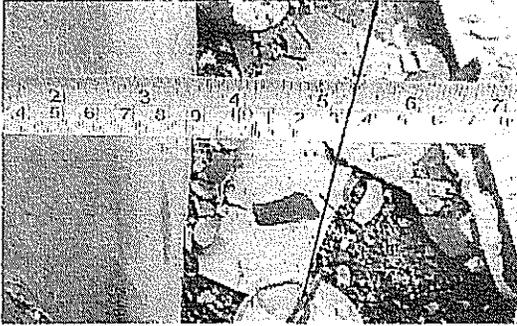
Vista de la medición del desaplome del muro ubicado en el eje 3A.
